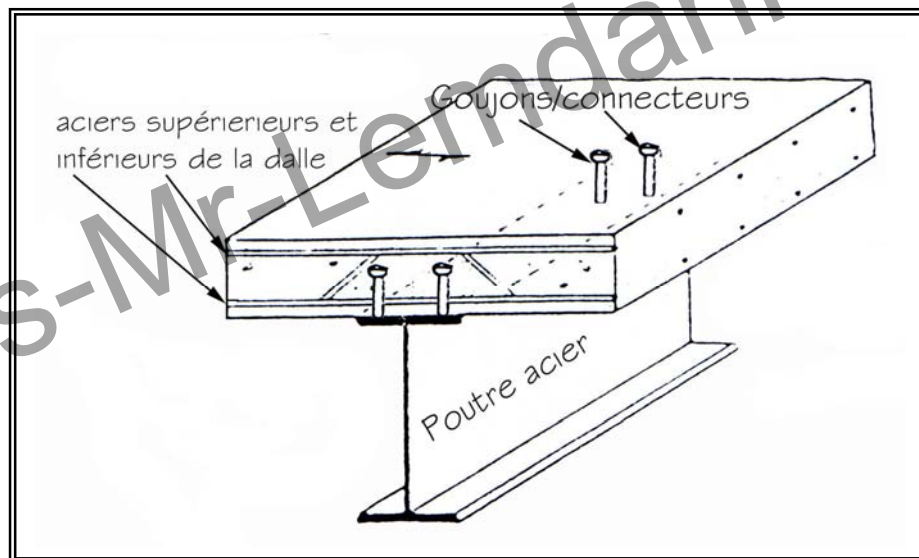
Plancher mixte collaborant avec dalles en béton armé coulées
